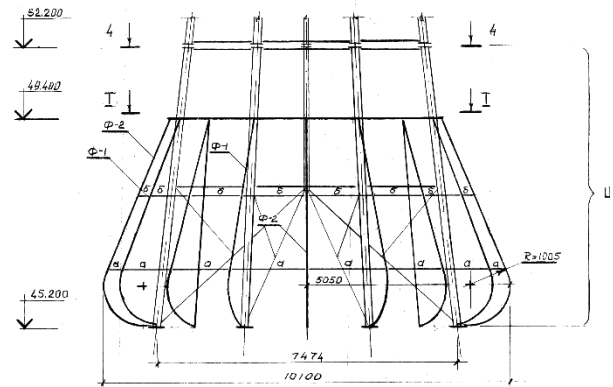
Креслення металевих конструкцій нижньої частини шпиля дзвіниці
